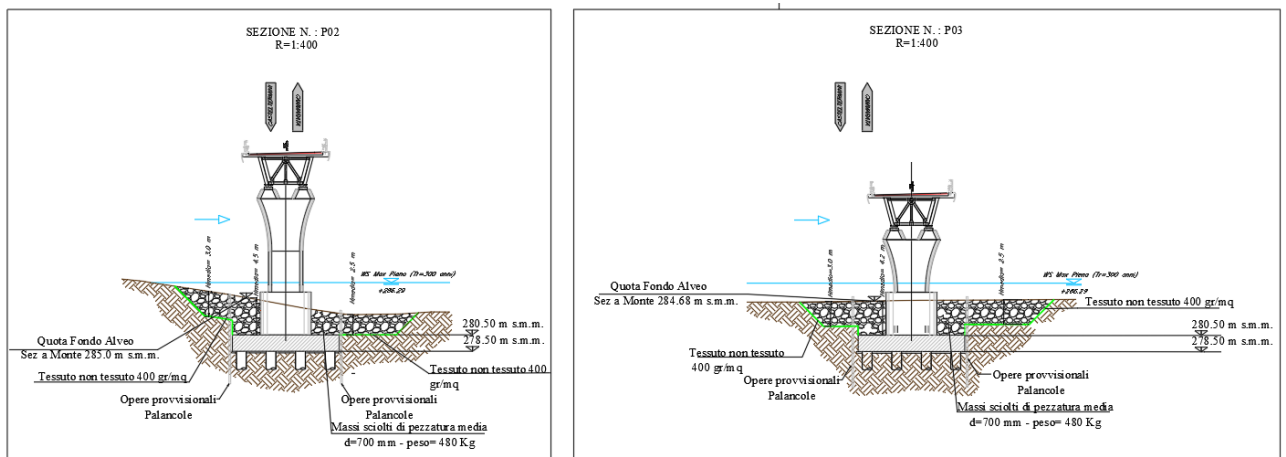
Sezione Protezione in riprap per le pile 2 e 3.
